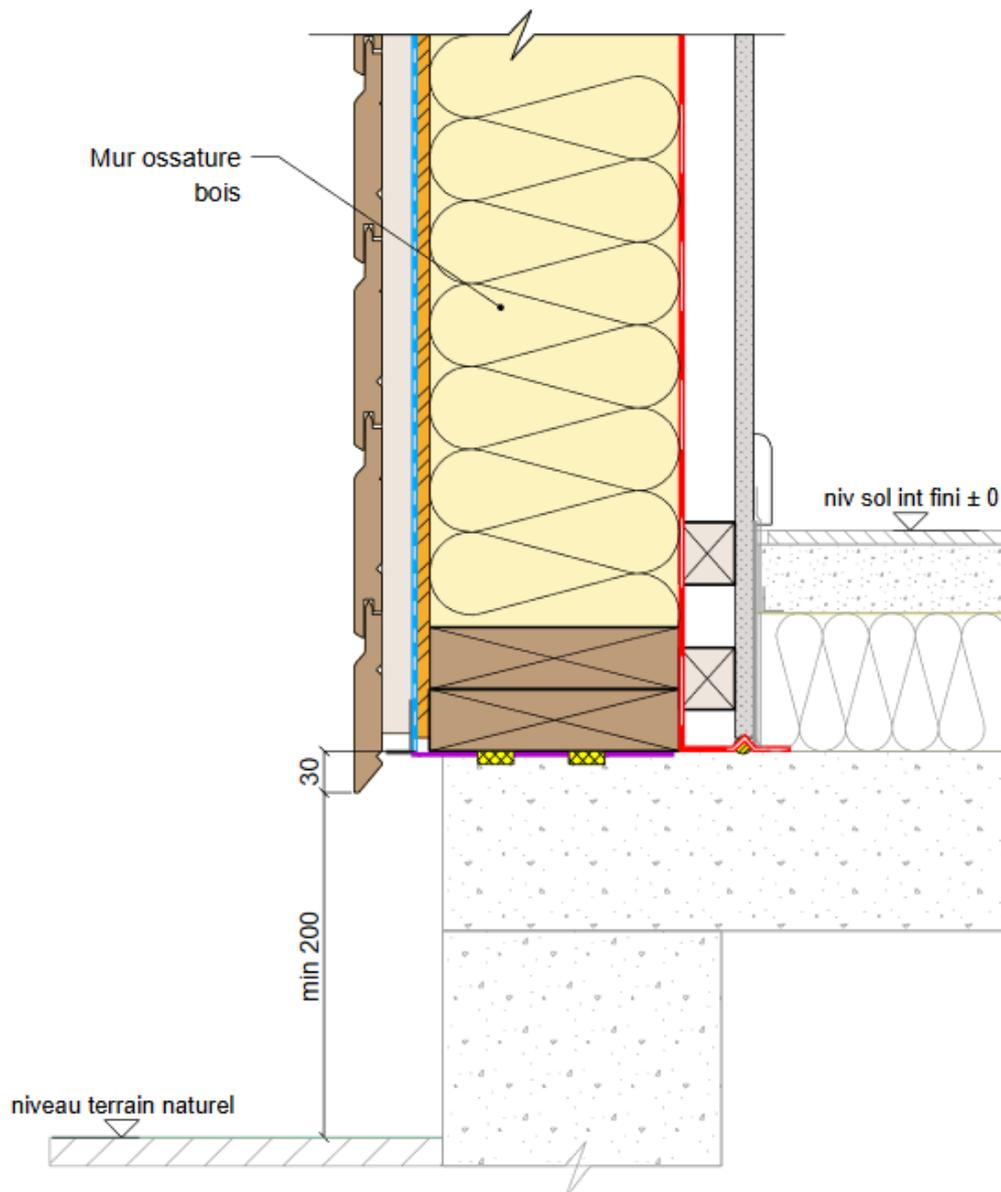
Illustration de la garde au sol d'un mur à ossature bois (coupe verticale)
